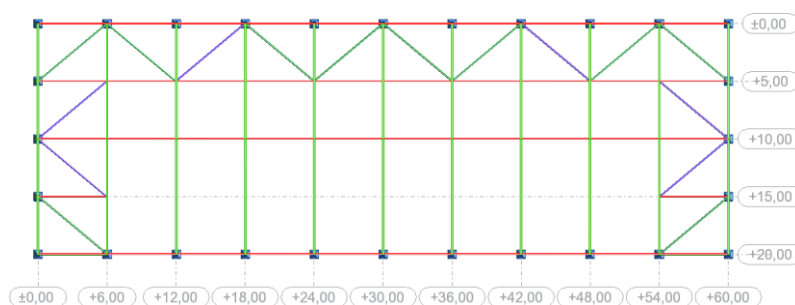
Exemplo da diferença de perfis aplicados no contraventamento em *portal frames* - vista em planta (caso de estudo PF20-6)
